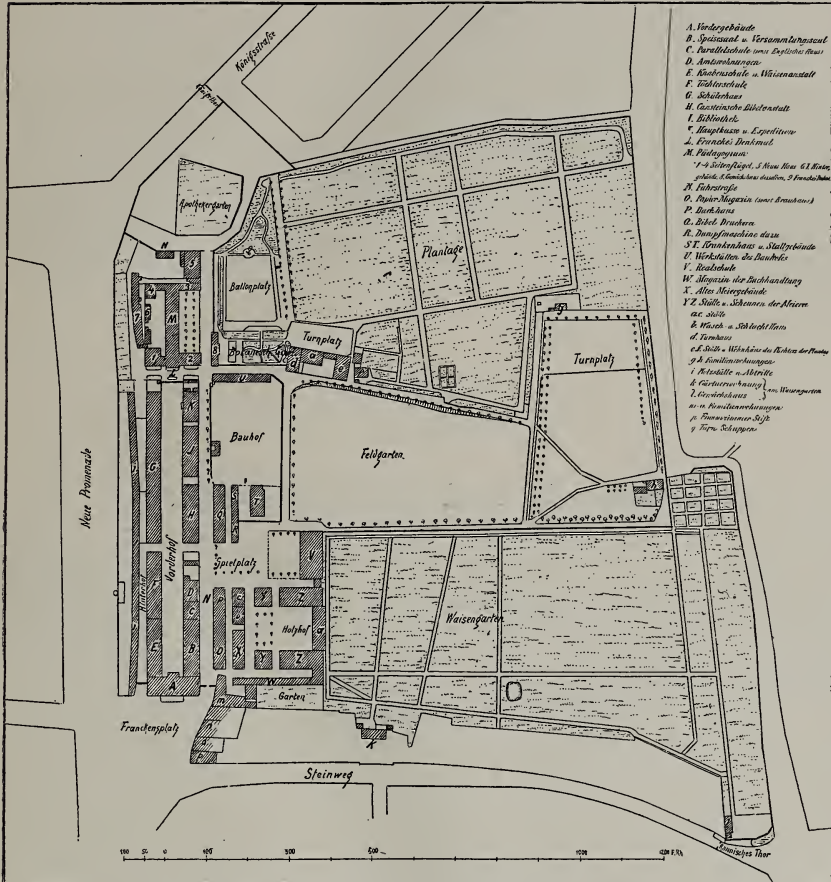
Plan der Francke'schen Stiftungen zu Halle.
